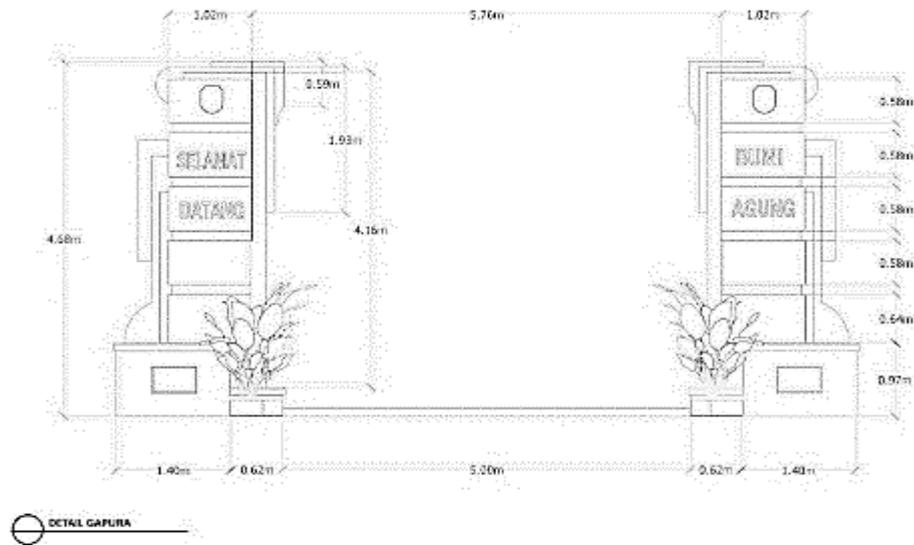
Tampak Depan Bangunan Gapura Masuk Desa Bumi Agung (Enscape)
